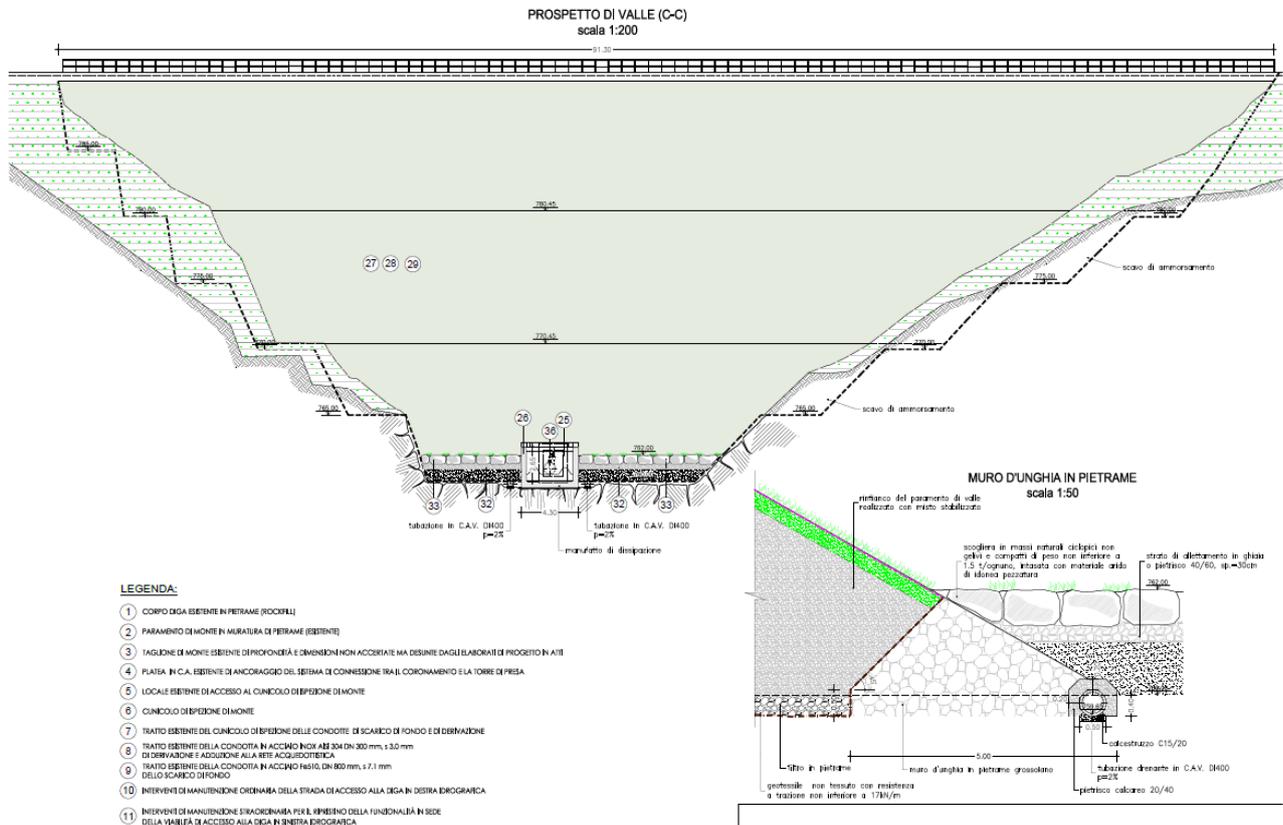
prospetto del rinfianco previsto nel paramento di valle.
